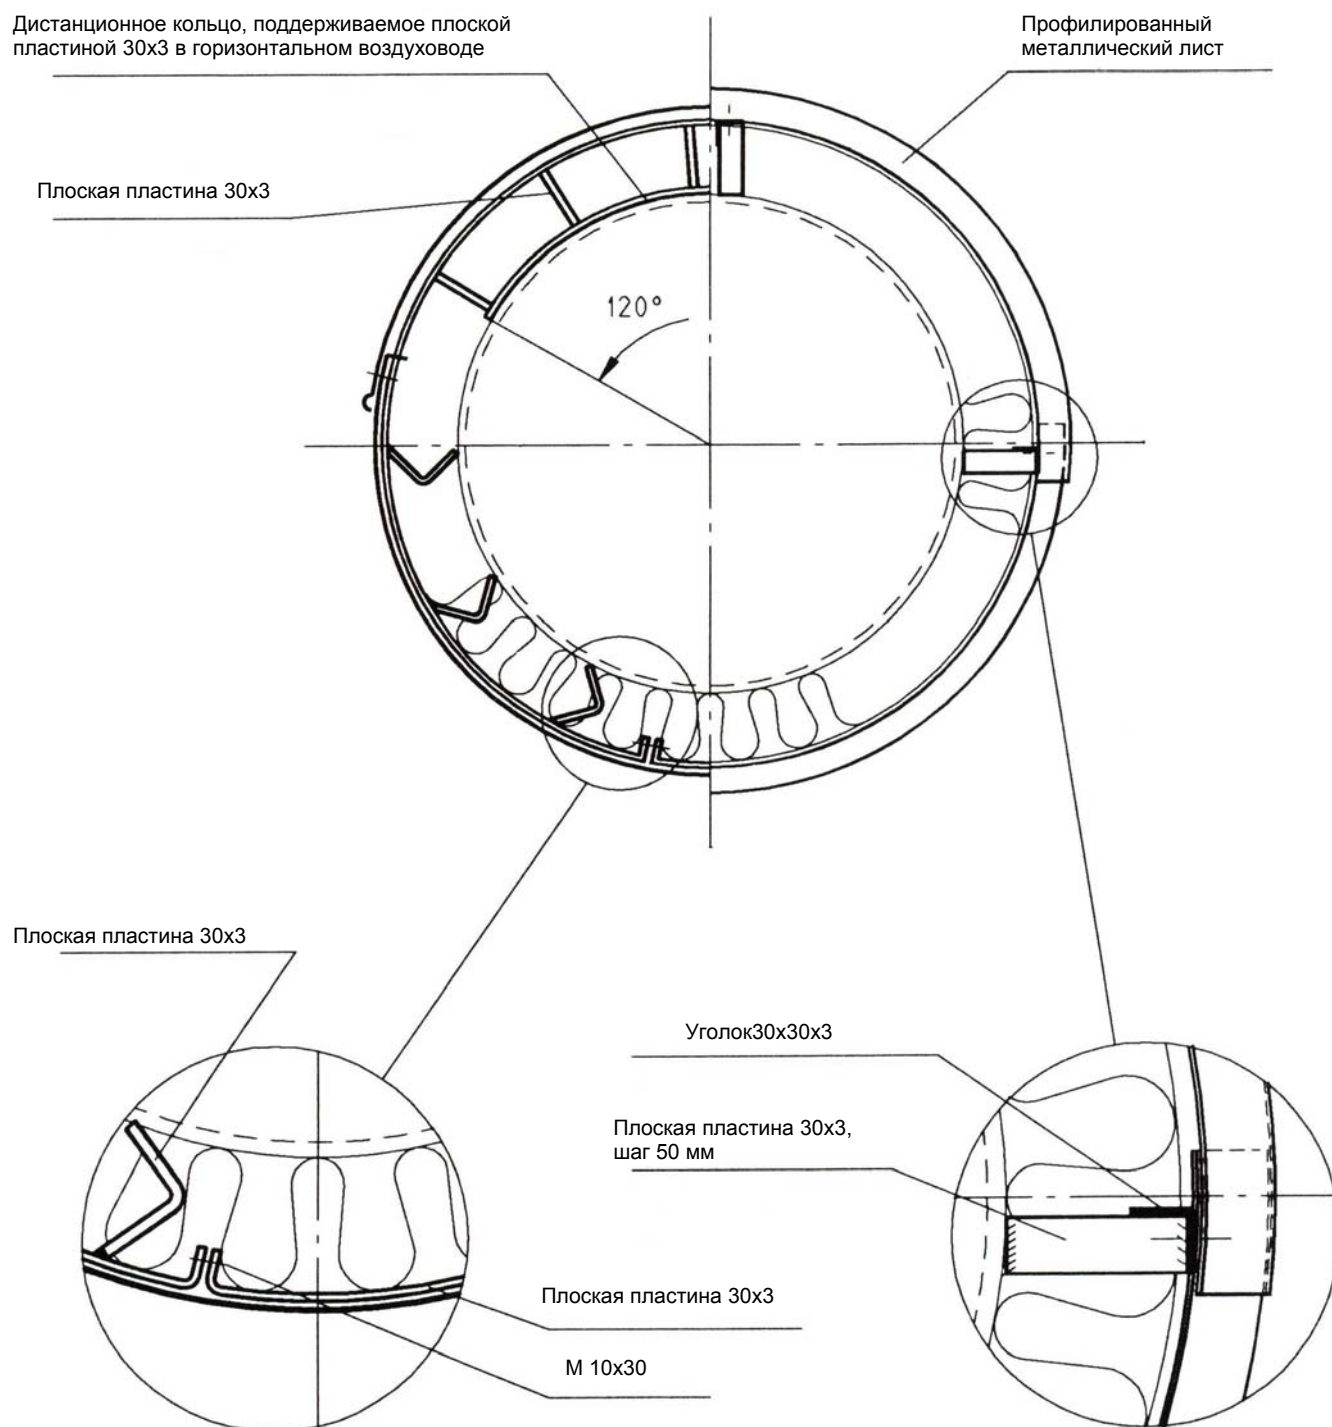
Изоляция воздухопроводов и газоходов круглого сечения с покровным слоем из листового металла или профилированного металлического листа
